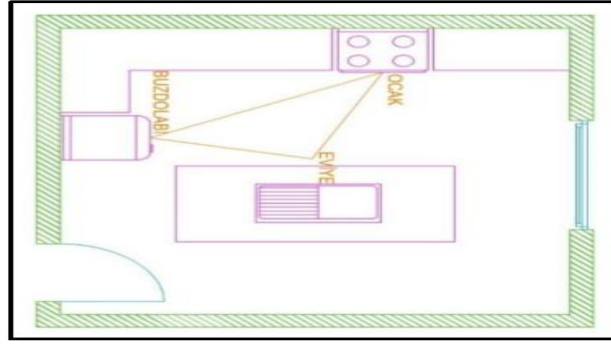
Koridor Tipi Mutfak Planı (Oruç, 2014).
